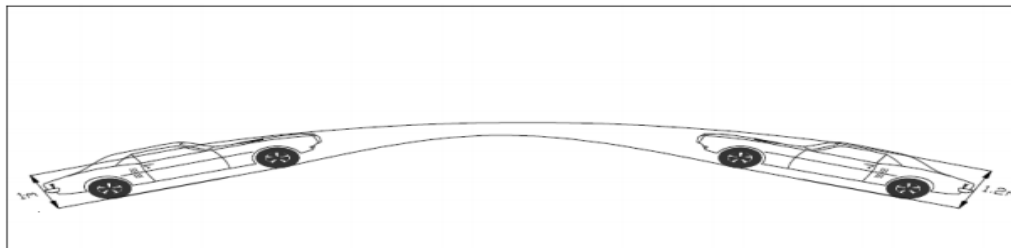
Visibilité en courbe verticale convexe sur chaussée bidirectionnelle.
